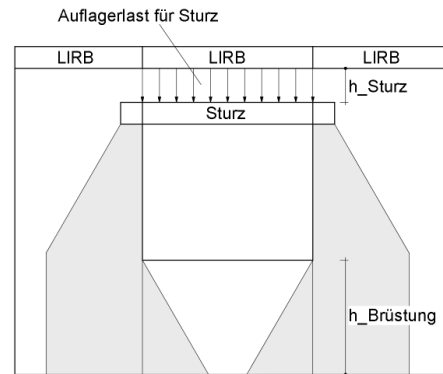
Lastübergabe bei Wandabschnitt mit Aussparung
